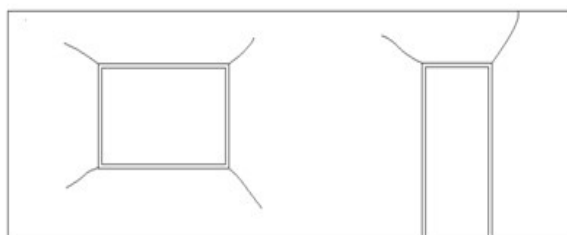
Fissuras nos cantos dos vãos de portas e janelas, decorrentes da ausência de vergas e contraverga.
